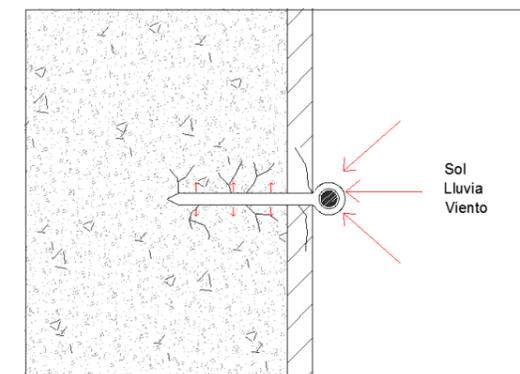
Detalle causas fisuración revestimiento. Fuente: autor propio
